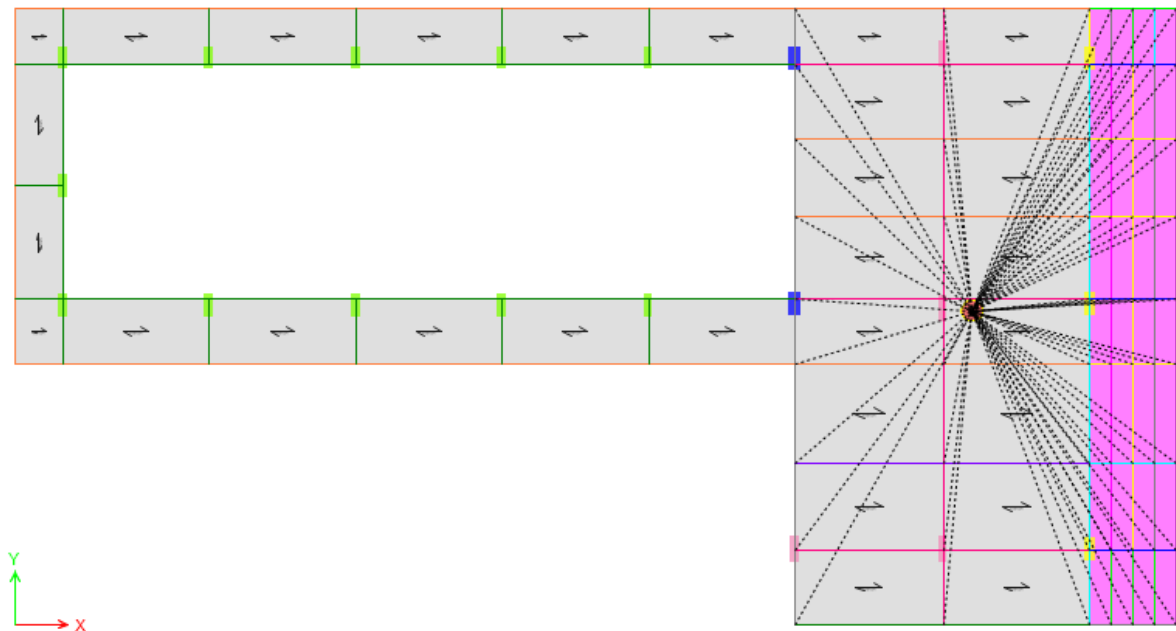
Diafragma Planta Piso 1 N+3.60m Restaurante
